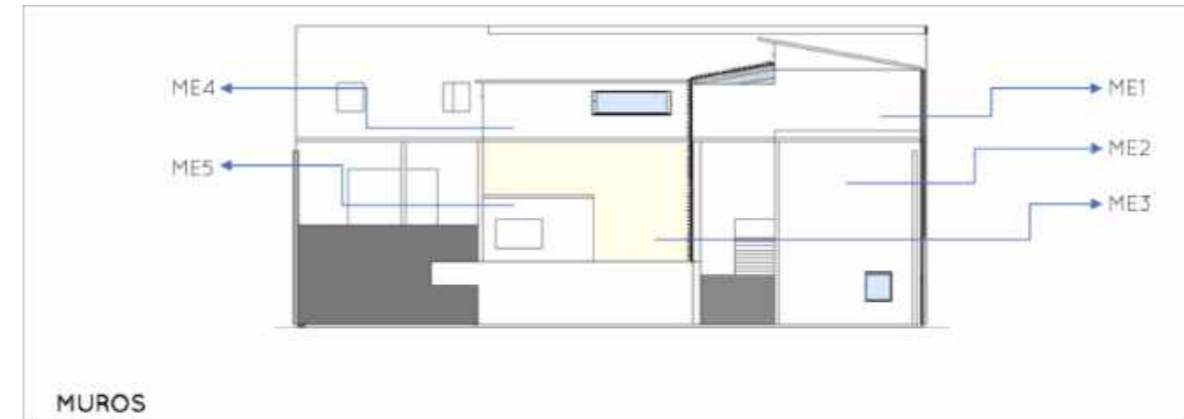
Nomenclatura en muros de fachada este. Fuente: Elaboración propia
